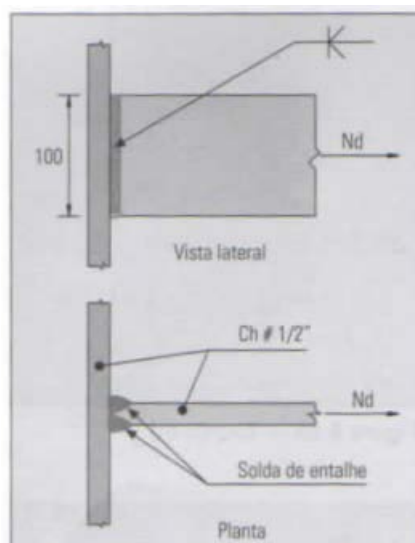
Exemplo 4.6.1 do Pfeil para solda de entalhe
